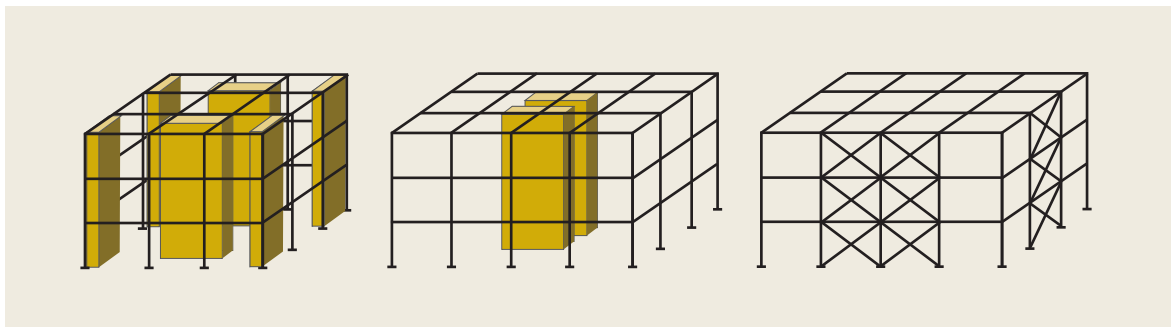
Distintos sistemas duales, a) con muros de concreto armado, b) con núcleos y c) con arriostros laterales (Elaboración propia).
